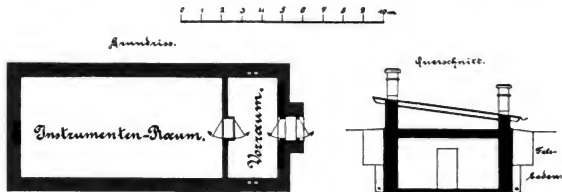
Grundriß und Querschnitt des Erdbebenhauses.
